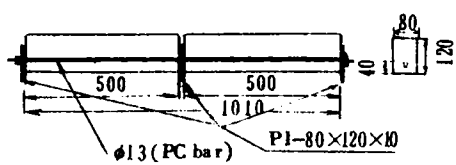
試験供試体の形状寸法および鋼棒の配置 (mm)
